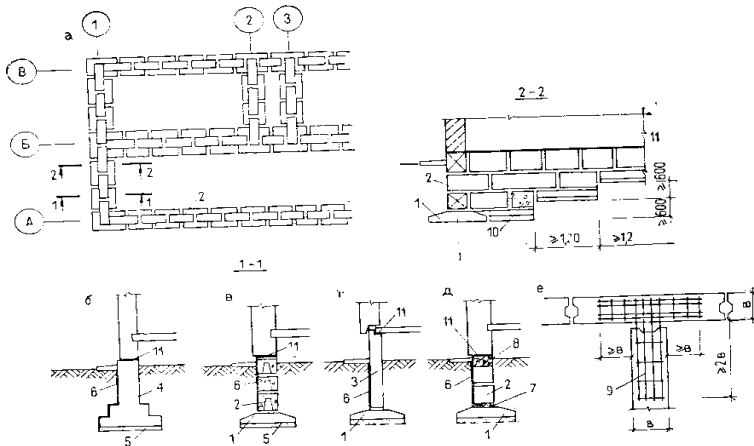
Стрічкові фундаменти: а - фрагмент плану збірних фундаментів з бетонних блоків, січення фундаментів: б - з монолітного бетону; в - з пустотілих бетонних блоків; г - панельні; д - збірно-монолітні; е - армування горизонтальних швів у місцях пересікання збірних стінових фундаментних блоків: 1 - залізобетонна збірна фундаментна плита (подушка); 2 - бетонний блок; 3 - цокольна панель; 4 - монолітний бетон (бутобетон); 5 - піщана подушка; 6 - обмазочна гідроізоляція; 7 - армований шов; 8 - залізобетонний монолітний пояс; 9 -
